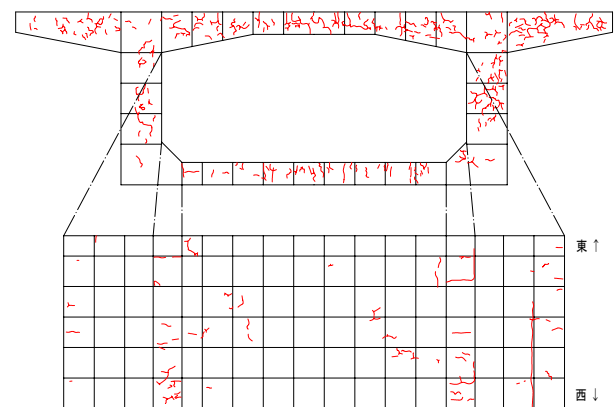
箱桁供試体 MODEL-B (収縮:標準) のひび割れ状況展開図
